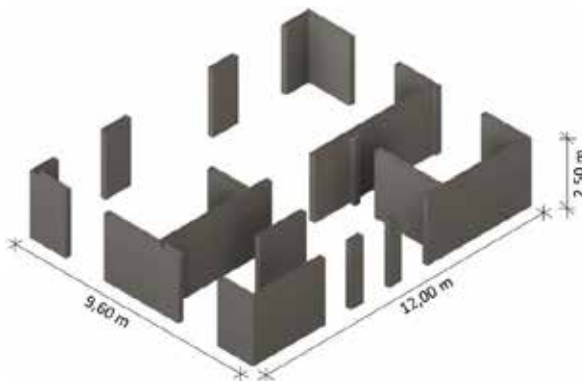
Visualisierung der gedruckten Schalung eines Geschosses (Grundriss entnommen aus [3])
